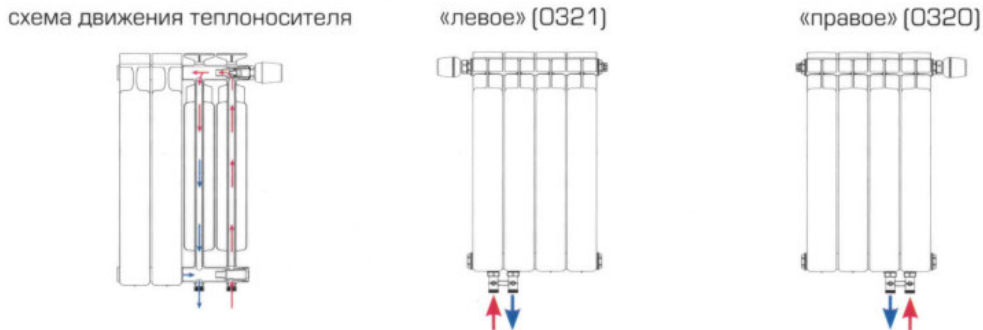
Возможные схемы нижнего подключения (O320/O321) радиаторов STOUT Space Ventil к трубопроводам системы отопления
